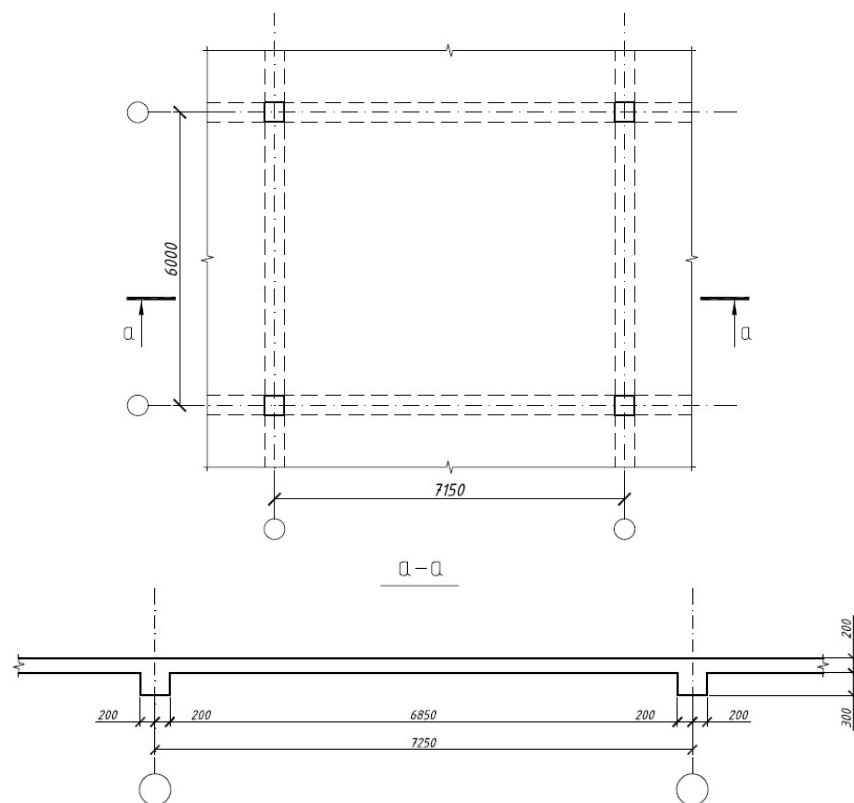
Схема типової комірки плити перекриття будівлі
